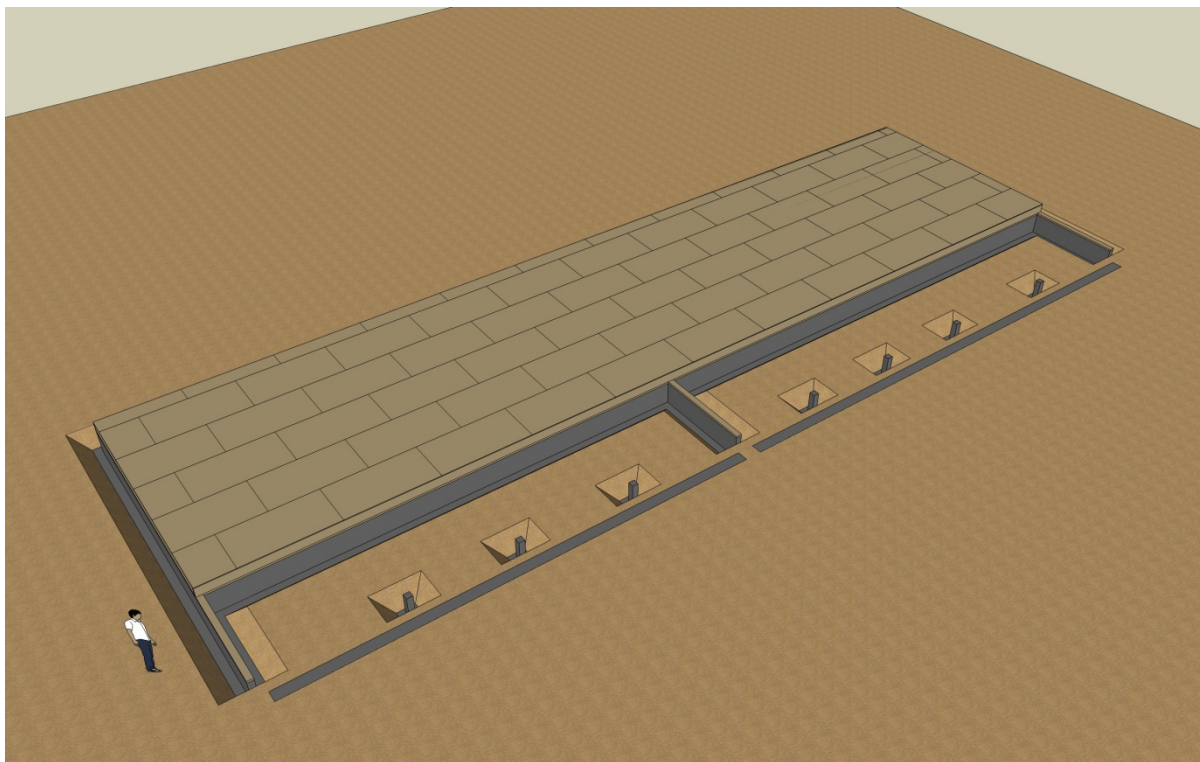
Montagem do forro estrutural de pavimento para formação do diafragma.
